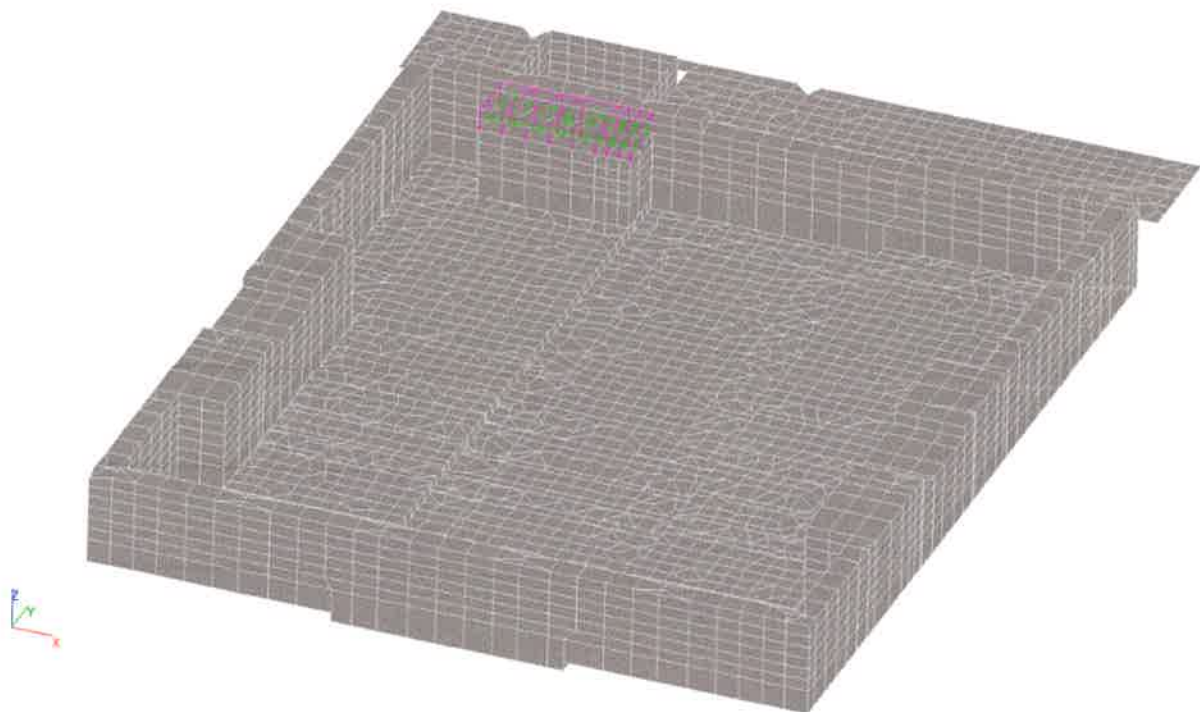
Схема приложения нагрузки от веса бетонных блоков над входом
